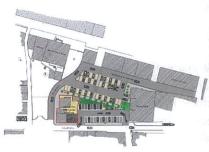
| Projeto estruturante 10 – ficha de projeto.
